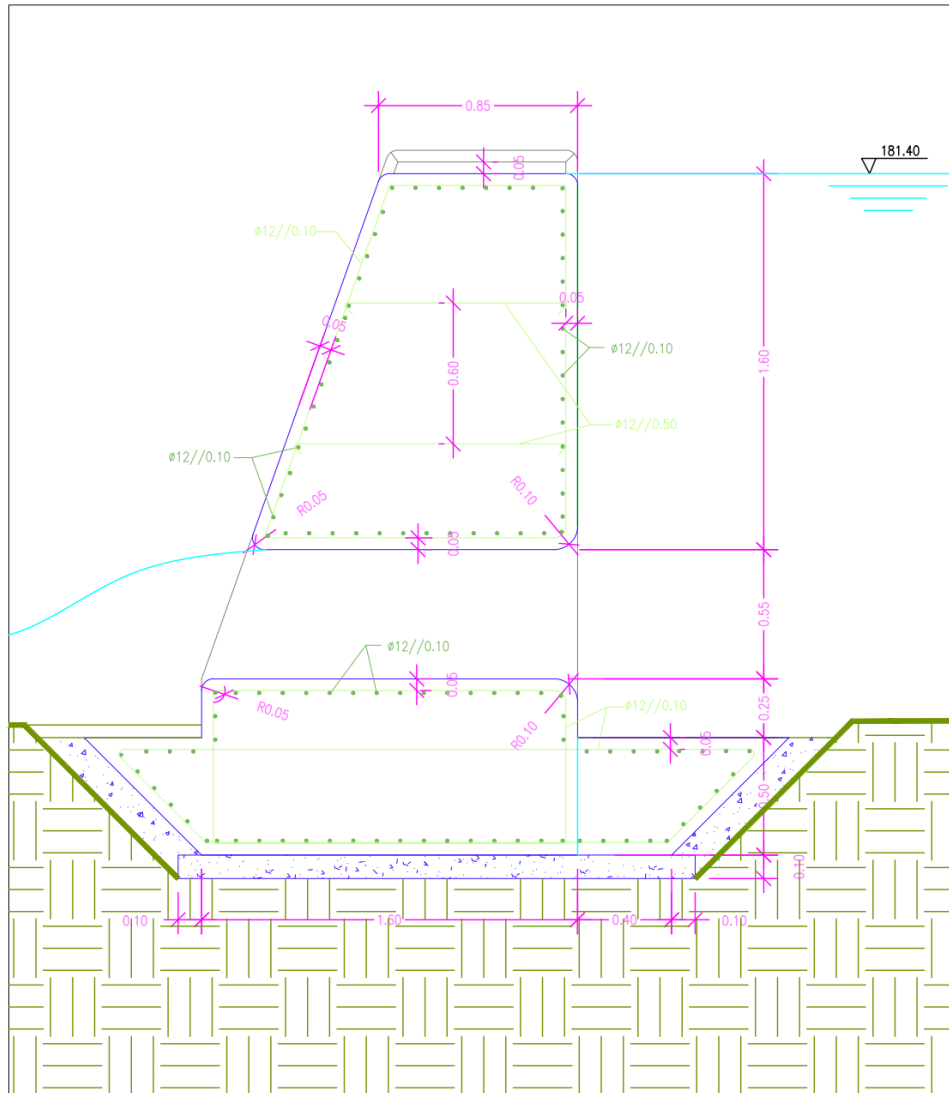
Corte A-A. Estrutura de retenção a Jusante. Fonte: Projegui.
